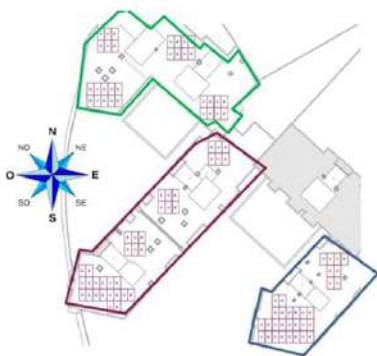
Disposición de los paneles en las distintas cubiertas de la comunidad. Fuente: Elaboración propia.
